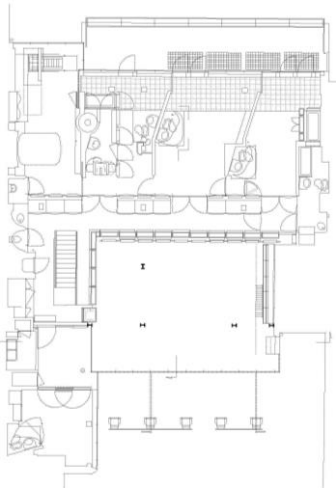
Pierre Chareau y Bernard Bijvoet, Planta Maison de Verre, 1928-1932
